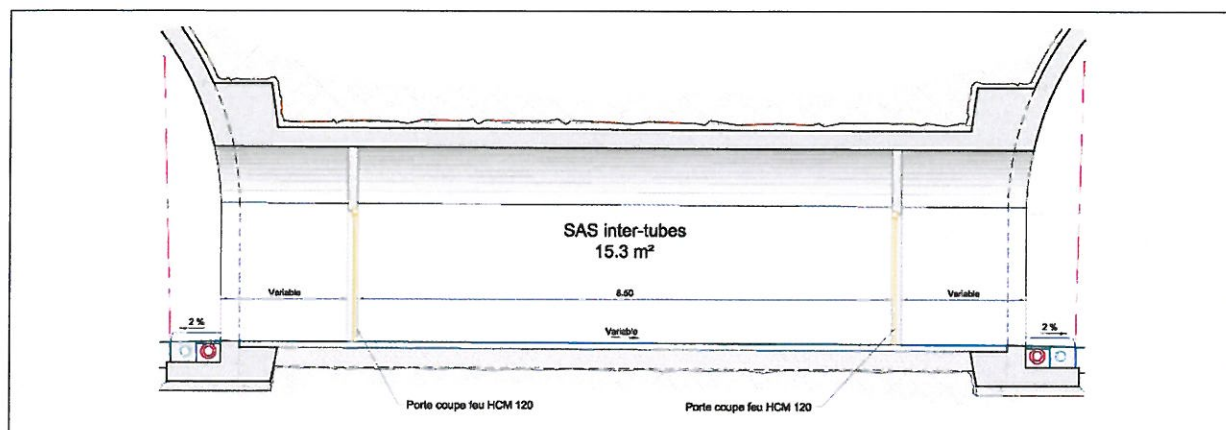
Coupe indicative d'une communication entre tubes piétons à construire
